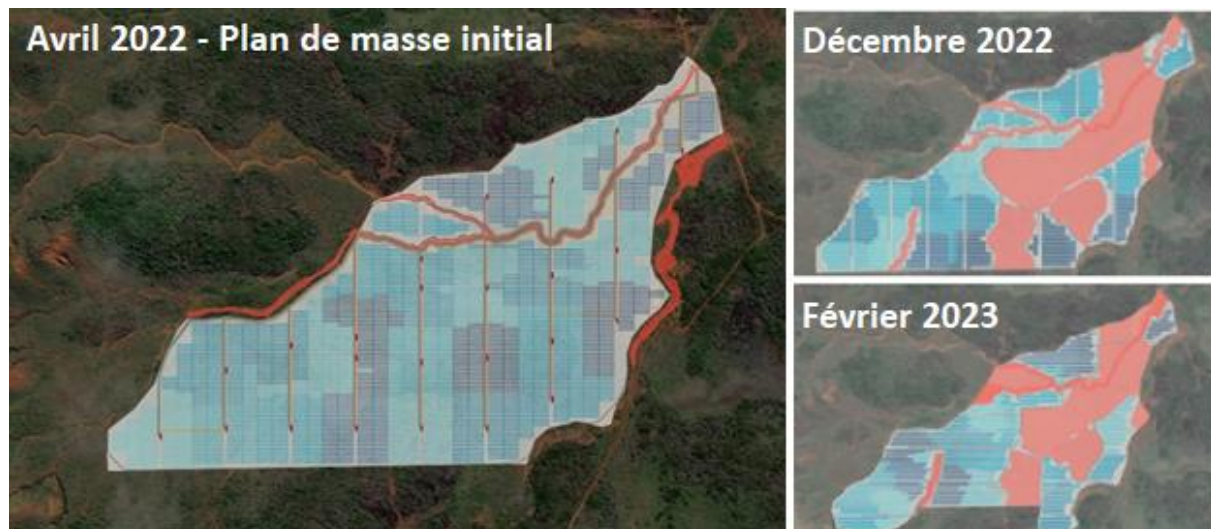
Evolution du plan de masse entre avril 2022 et février 2023.
